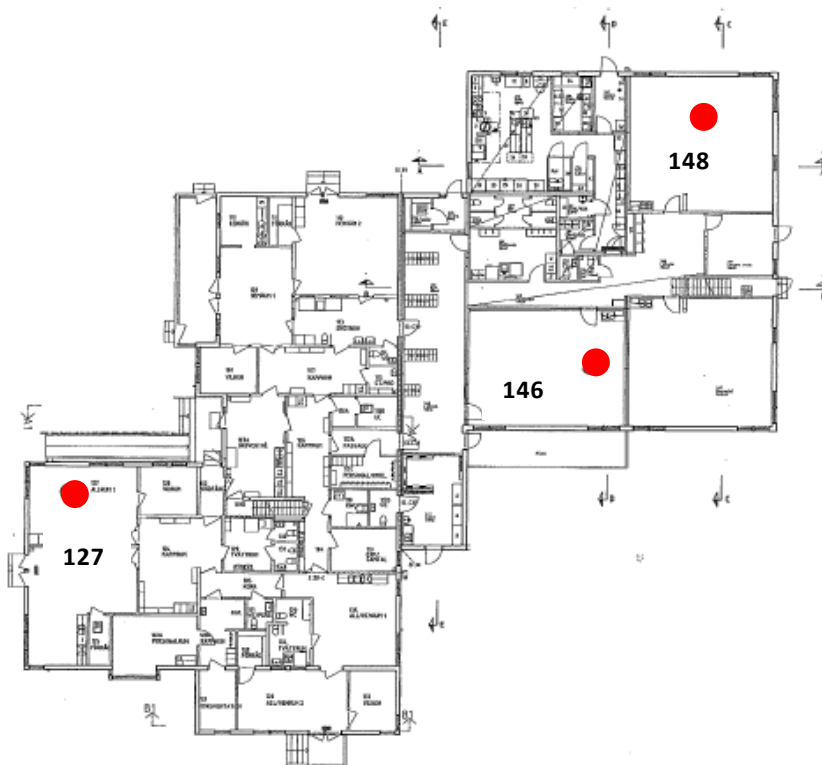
5. Förskolan Hovet, planritning, nedre plan. ● Provtagningsplats.
